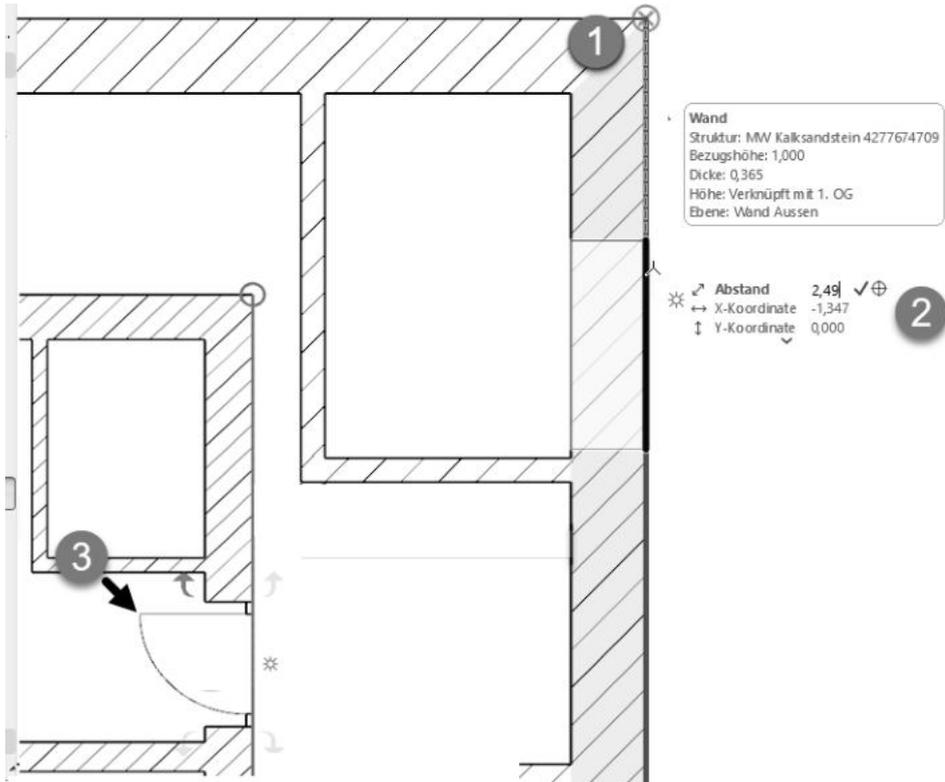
TÜR-Werkzeug und Aktivierung der Hilfslinie
